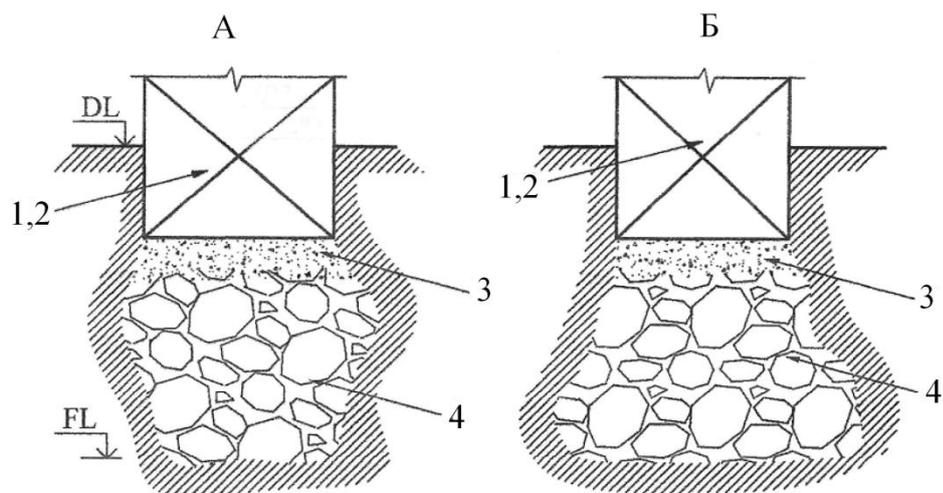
Конструктивные схемы бутовых фундаментов с трапециевидным поперечным сечением
